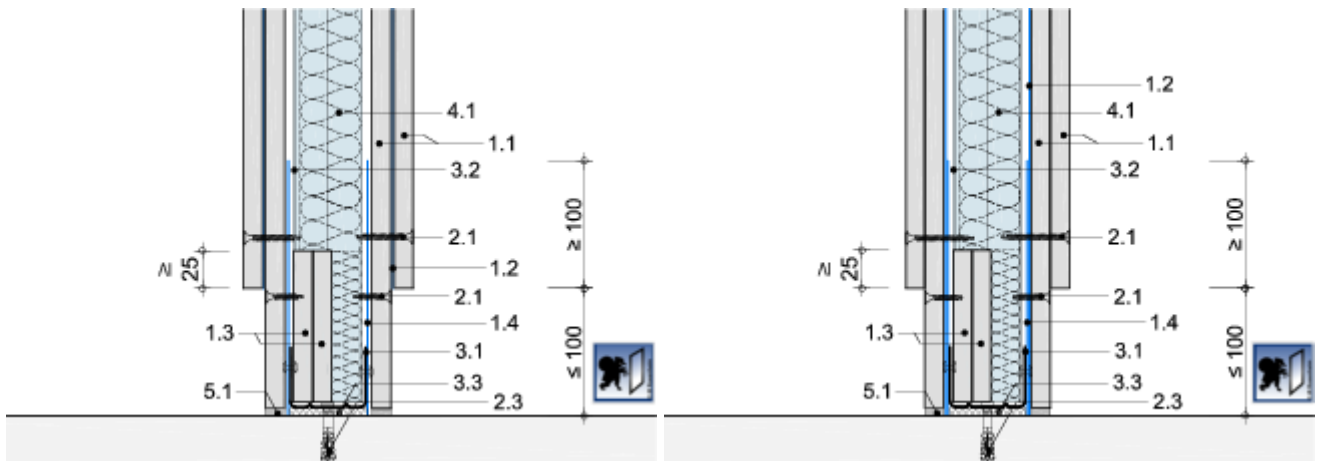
Fußpunkt Doppelständerwand RC 2
